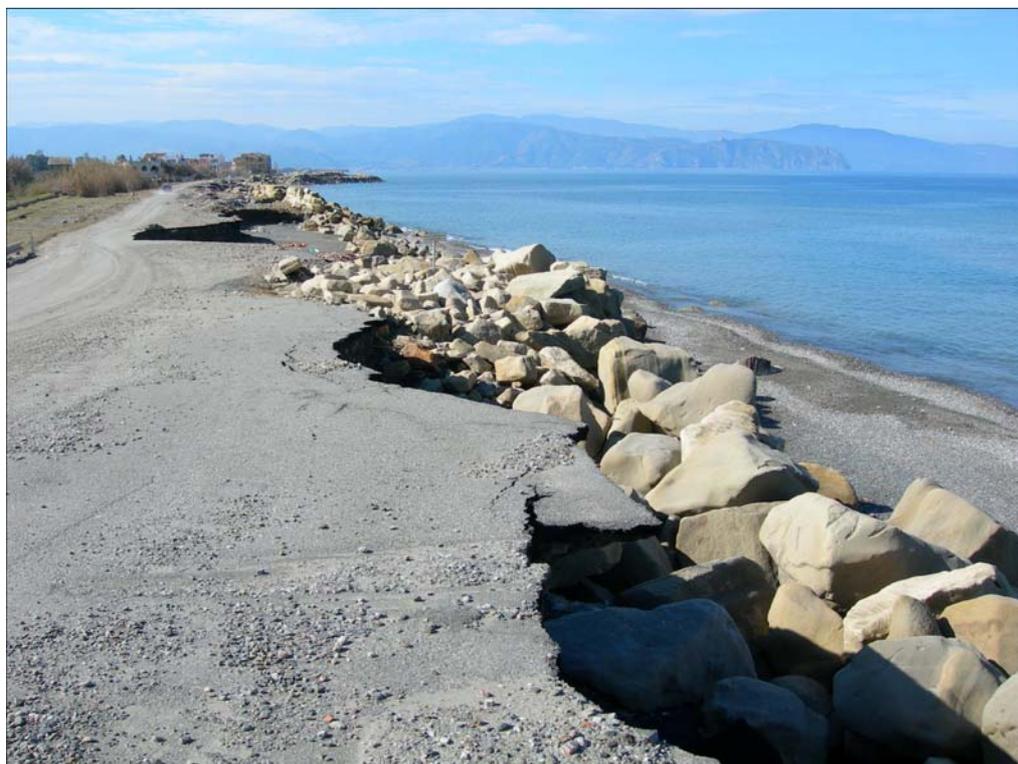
/N: Tratto della strada litoranea interessato dall'erosione costiera
